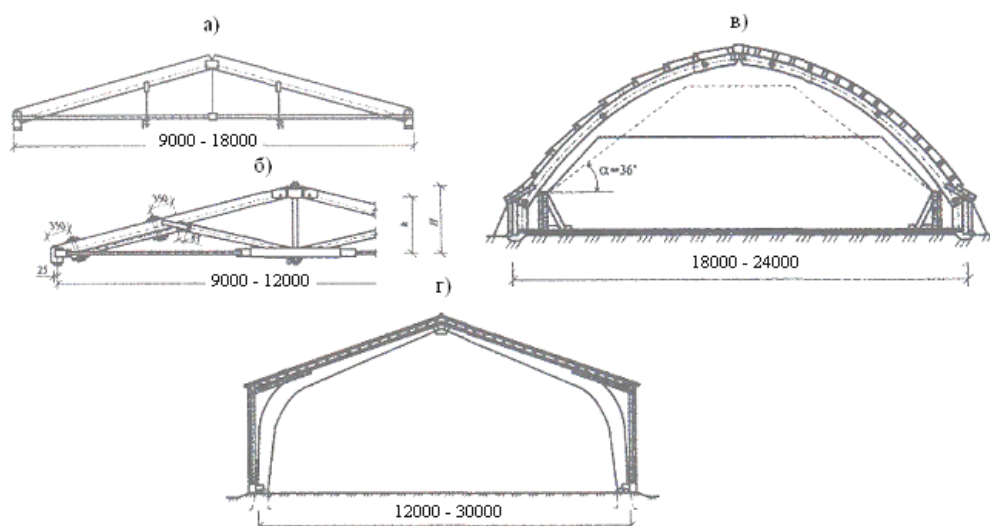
Варианты клеедеревянных стропильных конструкций
